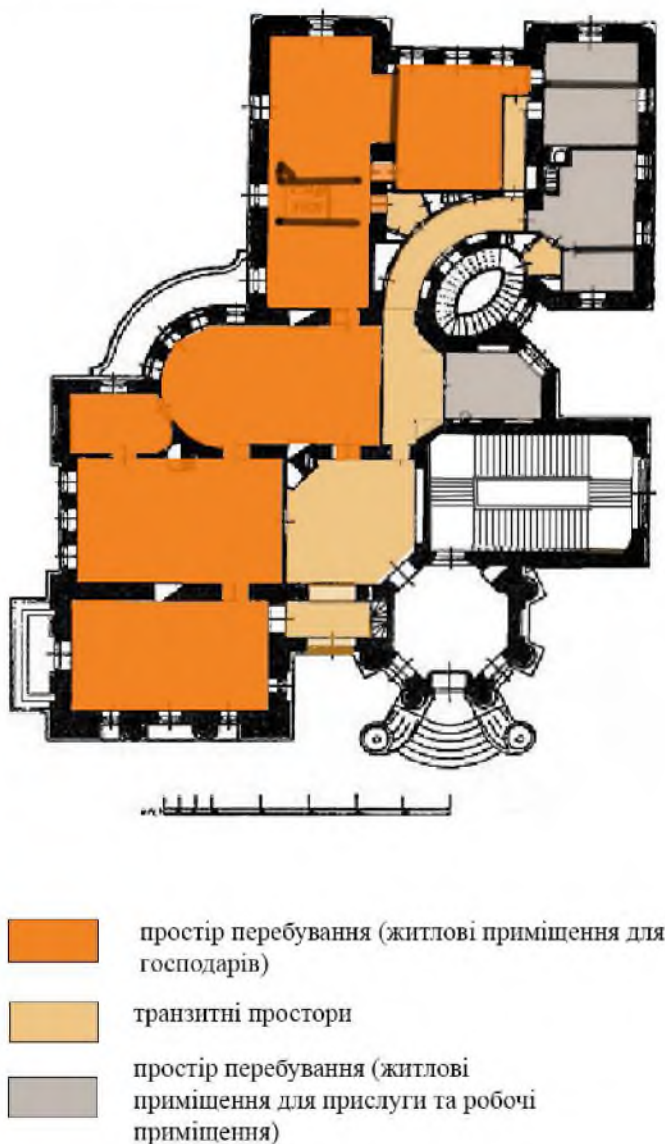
План 2-го поверху прибуткового будинку по вул. Ярославів Вал, 1
